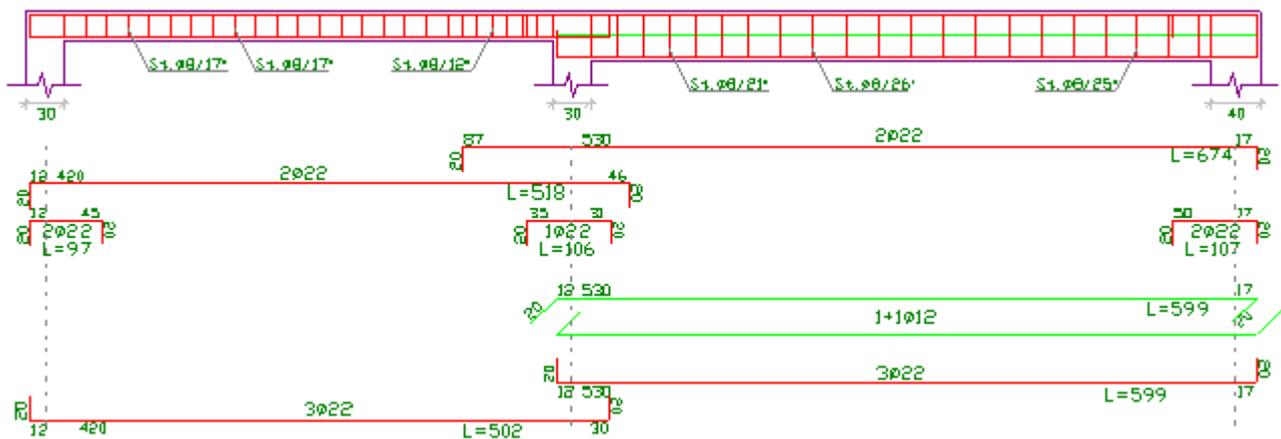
Sezione longitudinale della trave e distinta armatura.
